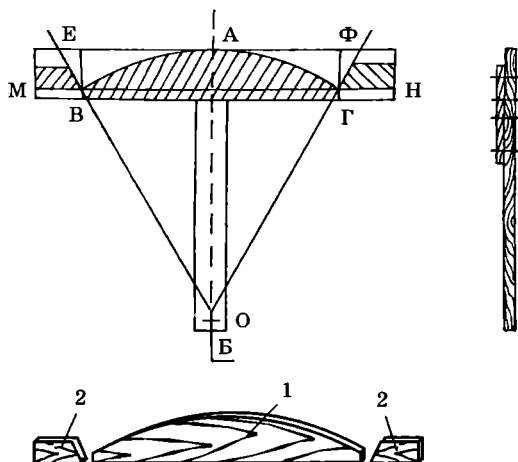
Разметка материала для изготовления кружал и шаблонов пят:
